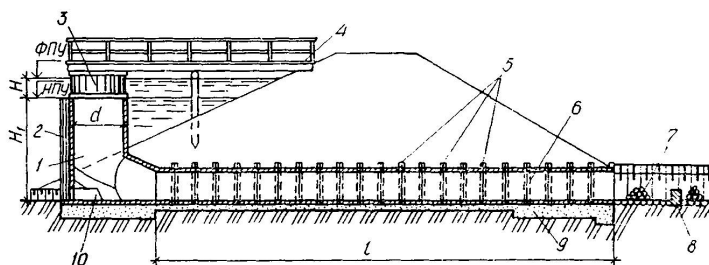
Башенный водосбор: 1 – башня; 2 – пазы для щитов; 3 – металлическая решетка; 4 – служебный мостик; 5 – муфты; 6 – отводящая труба; 7 – отводящий канал; 8 – водобойная стенка; 9 – бетонное основание; 10 – донное отверстие
